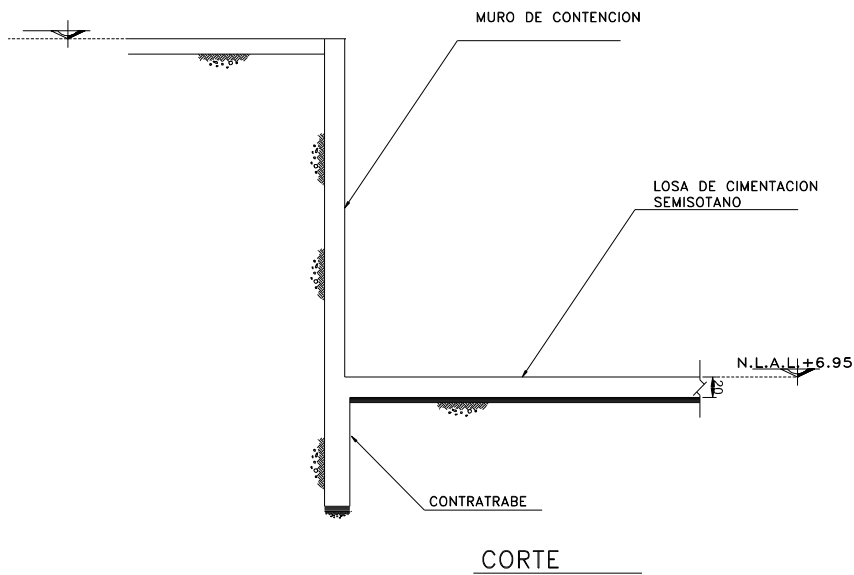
Corte esquemático de losa de fondo, contratraves y muros
